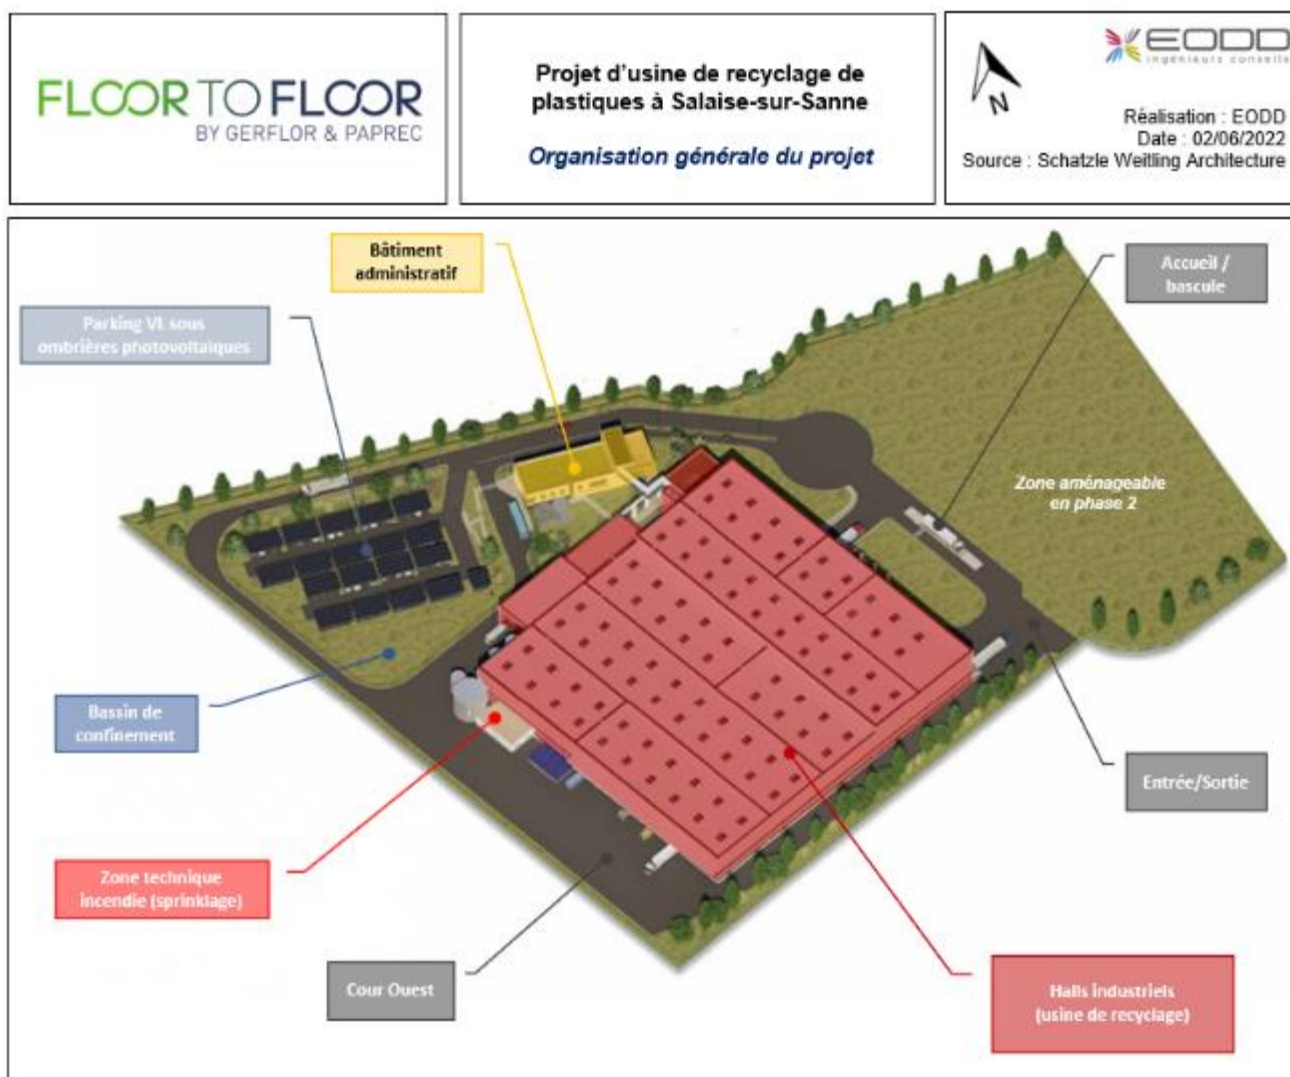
Plan d'aménagement du lot B (source : Schatzle Weitling Architecture)
